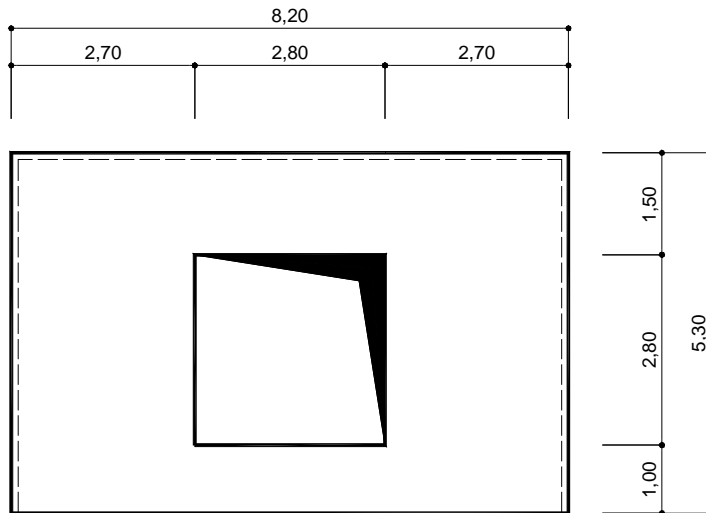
Grundriss der in Aufgabe 1 betrachteten Platte (Abmessungen in m).
